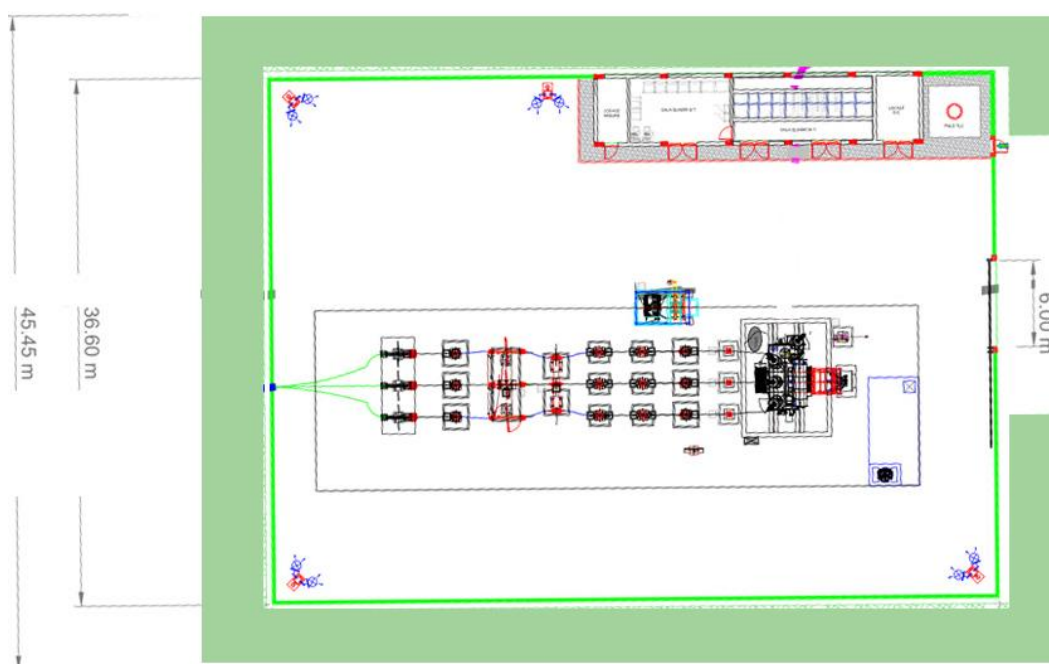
Planimetria della nuova Stazione Elettrica Utente SEU
